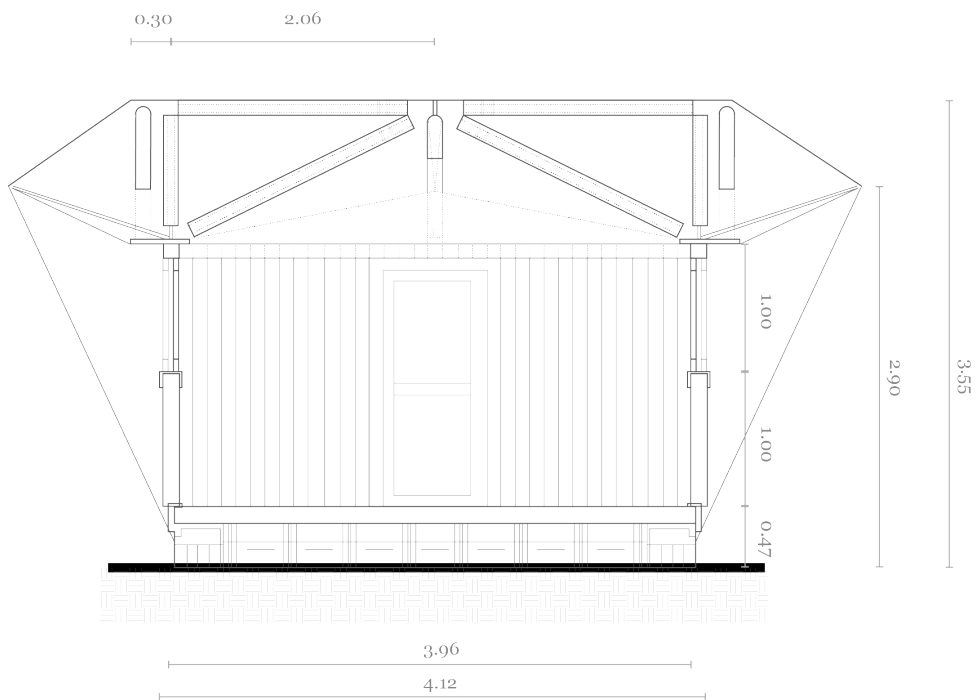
Sección A-A Paper Log House. Elaboración: Autores. Escala 1:50
